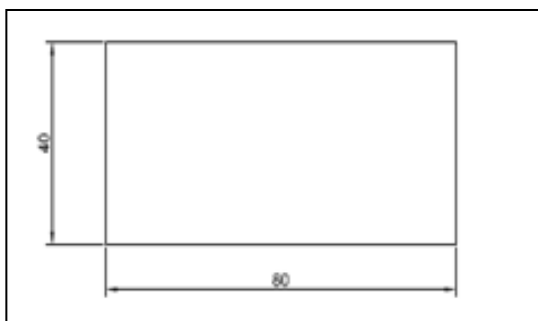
Plans de ferrailage des dalles de la latrine Ecosan
